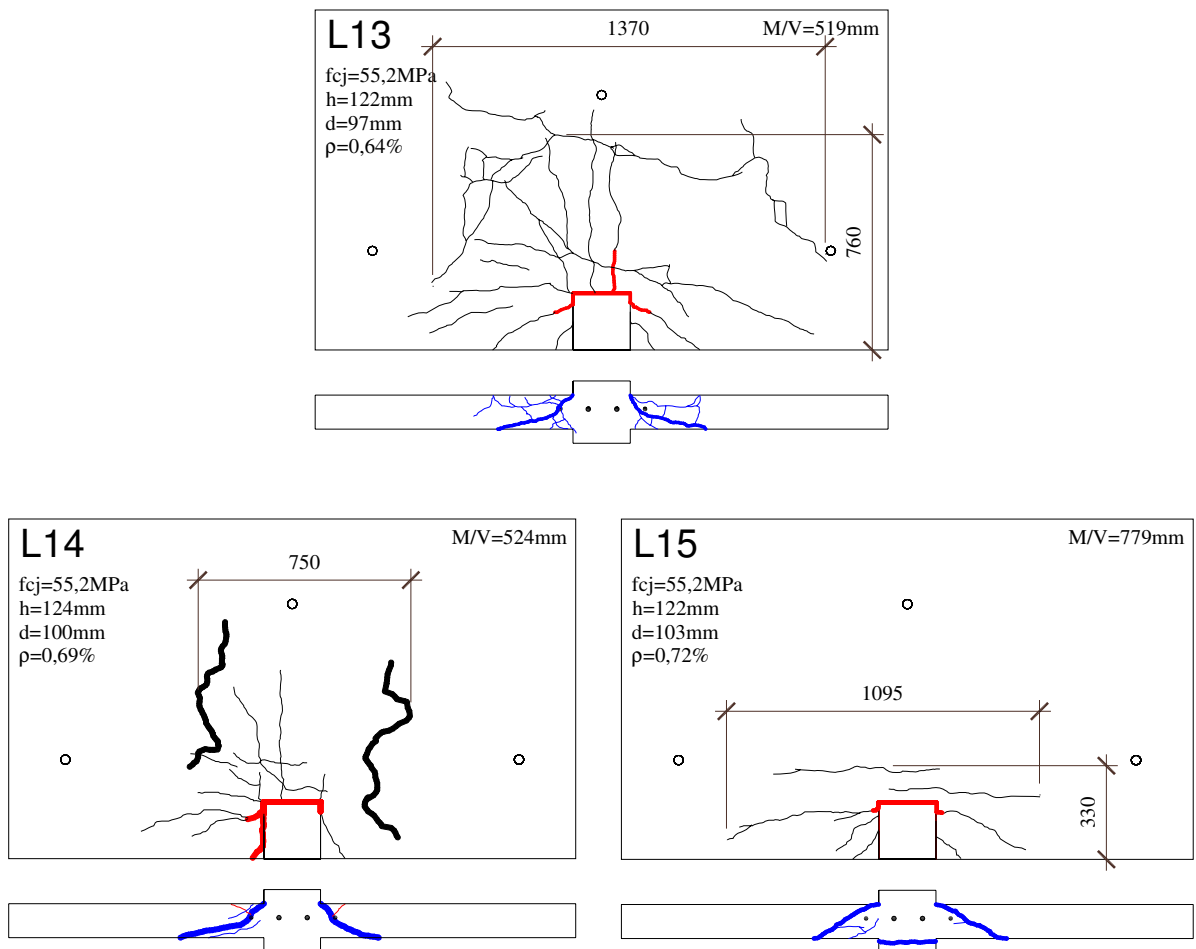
Fissuração e ruptura das lajes L13 a L15
